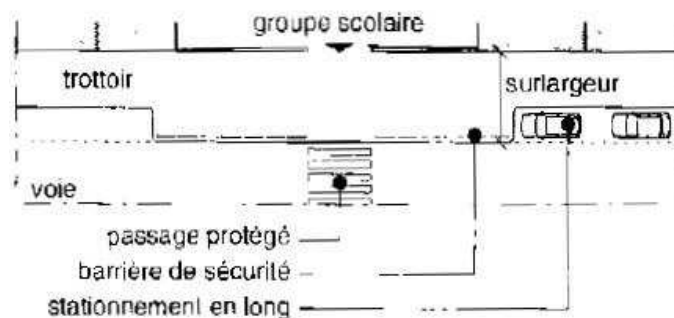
Dimensions, sur-largeur des trottoirs.
